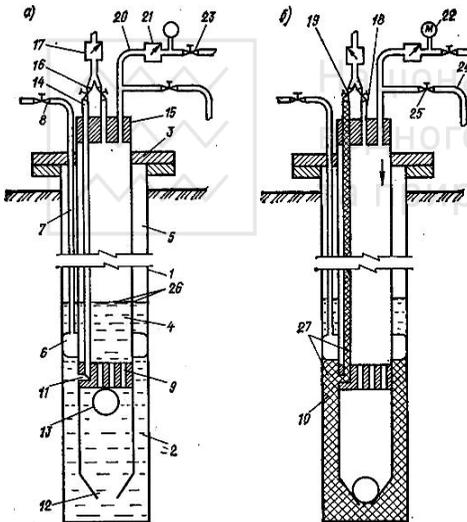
Пристрій для циклічної реагентної обробки:
